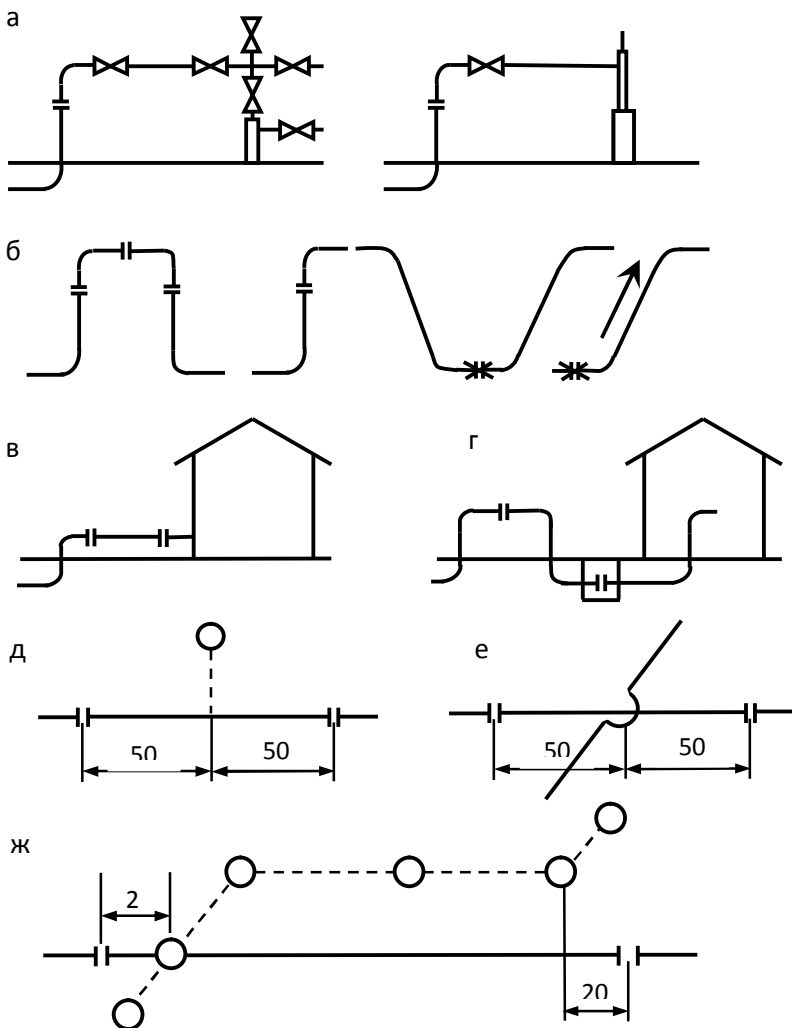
Рекомендуемые и не рекомендуемые (зачеркнуты крестиком) схемы установки ЭИС: а - на устьях нагнетальных и добывающих скважин; б - на нефтепроводах; в, г - на наземном и подземном вводе во взрывоопасное здание соответственно; д - в зоне влияния анодного заземлителя УКЗ; е - на пересечении с катодозащищенным трубопроводом; ж - на участке параллельного сближения с ЛЭП
